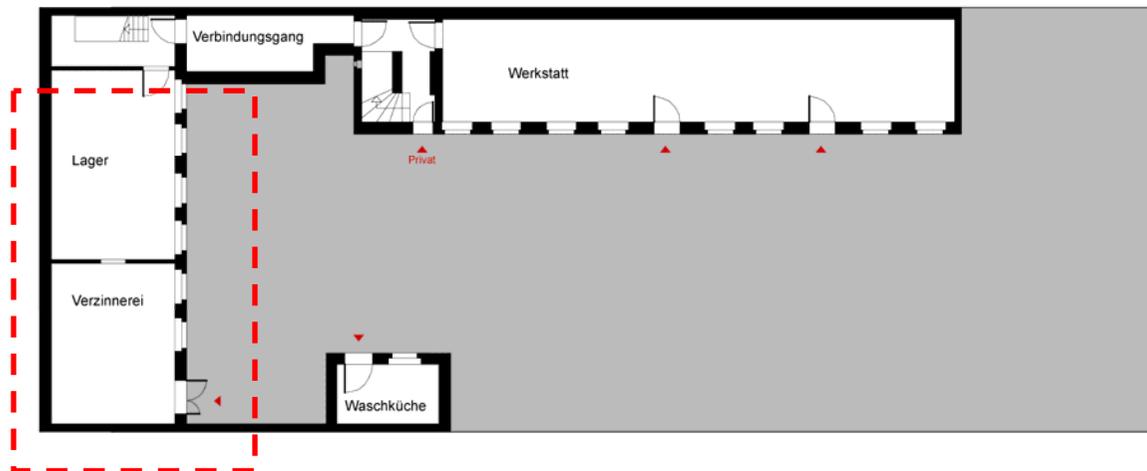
Grundriss Erdgeschoss nach der ersten Umbauphase,
